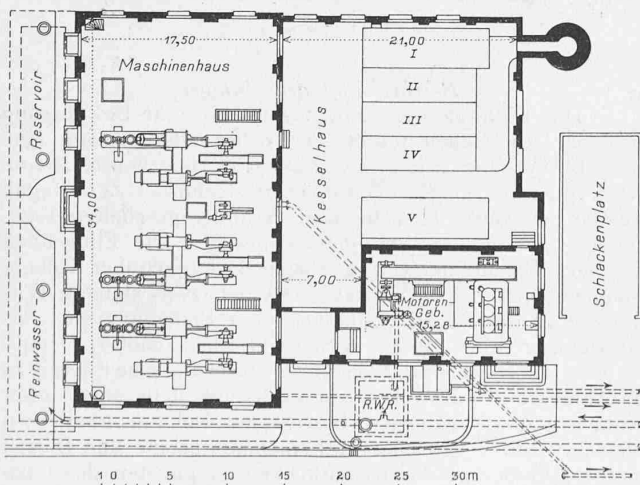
Grundriss der Pumpen-Anlage im Riet bei Rorschach. — 1 : 600.
